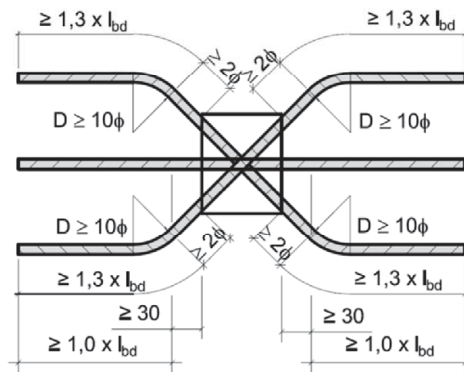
Horizontalstäbe geneigt und gerade für Schöck Isokorb® Typ H-VV-NN, Aufsicht
